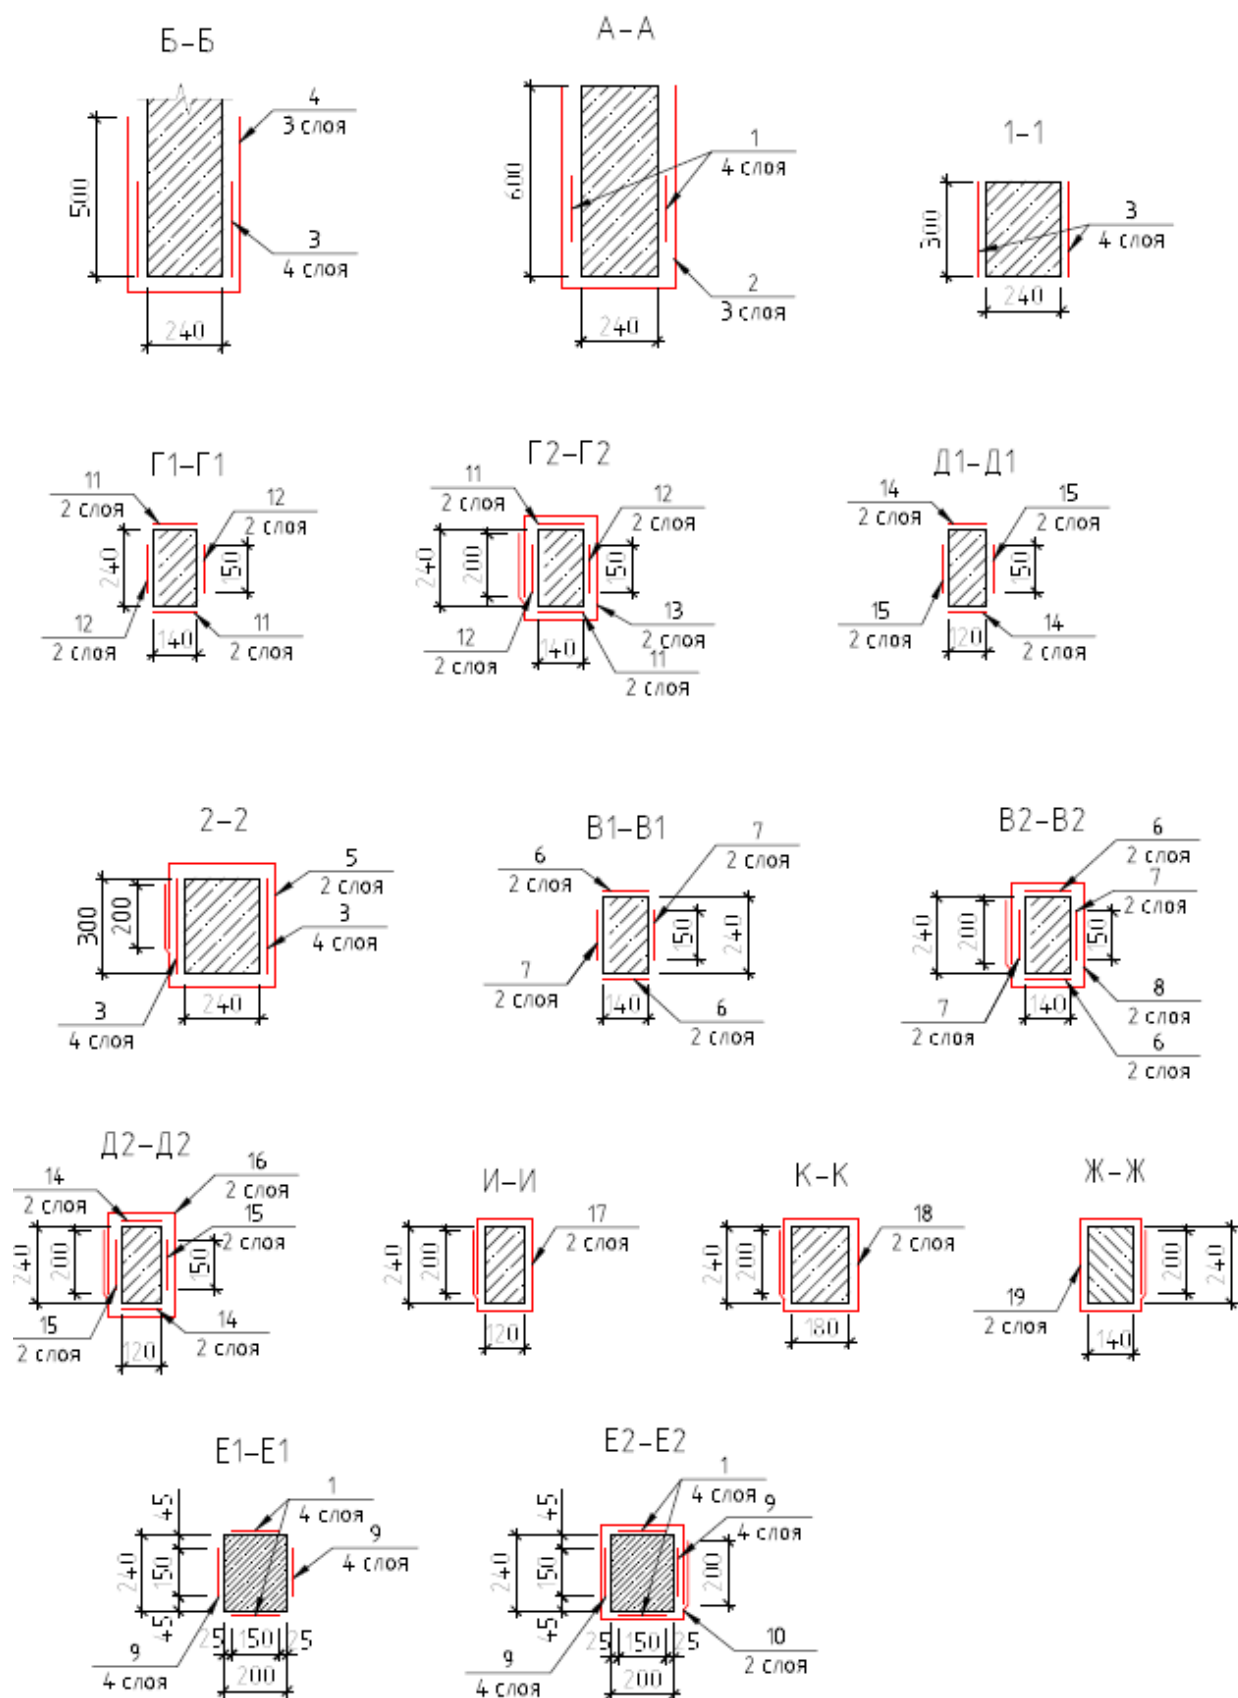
Усиление железобетонной фермы по серии Е-772П1
